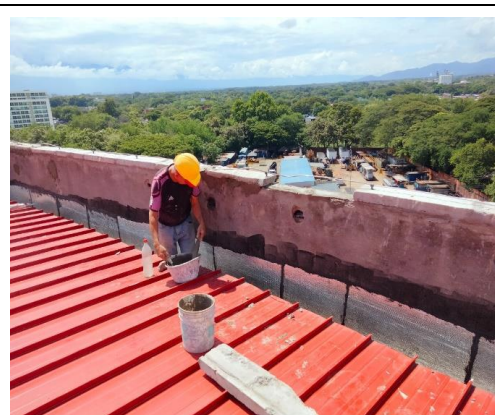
Reinstalación de alfajías en muro de cubierta de bloque 1.
